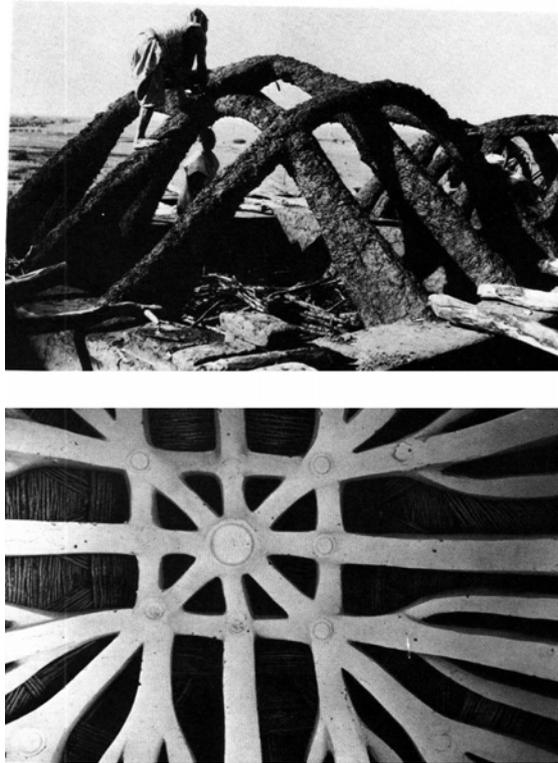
Arcos de tierra armada con madera, en el “Círculo de Tahoua en Níger”
